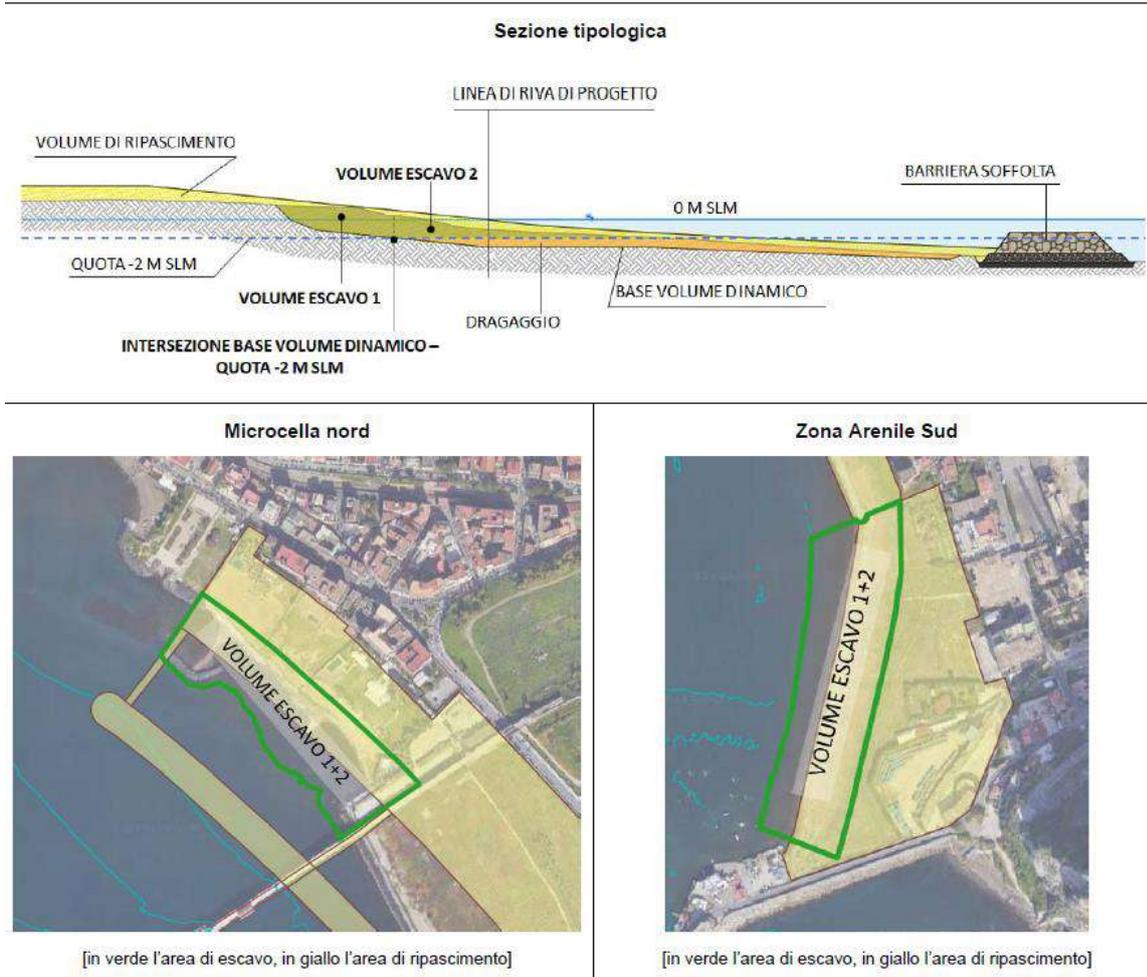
Rappresentazione del volume di escavo in sezione e in pianta
